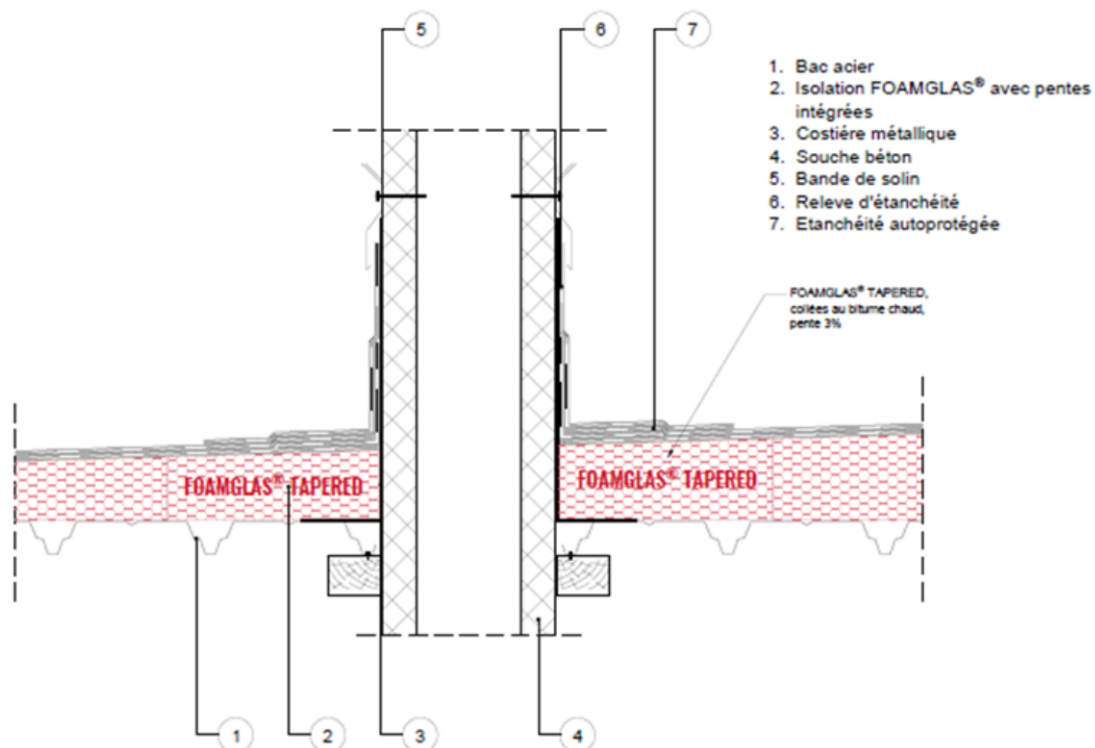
Coupe sur isolation de souche sur TAN en local TFH
